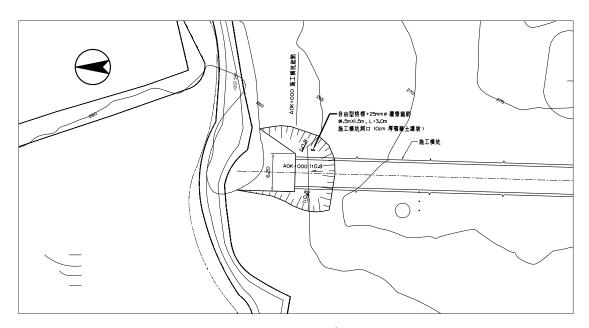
施工橫坑洞口邊坡開挖平面圖
